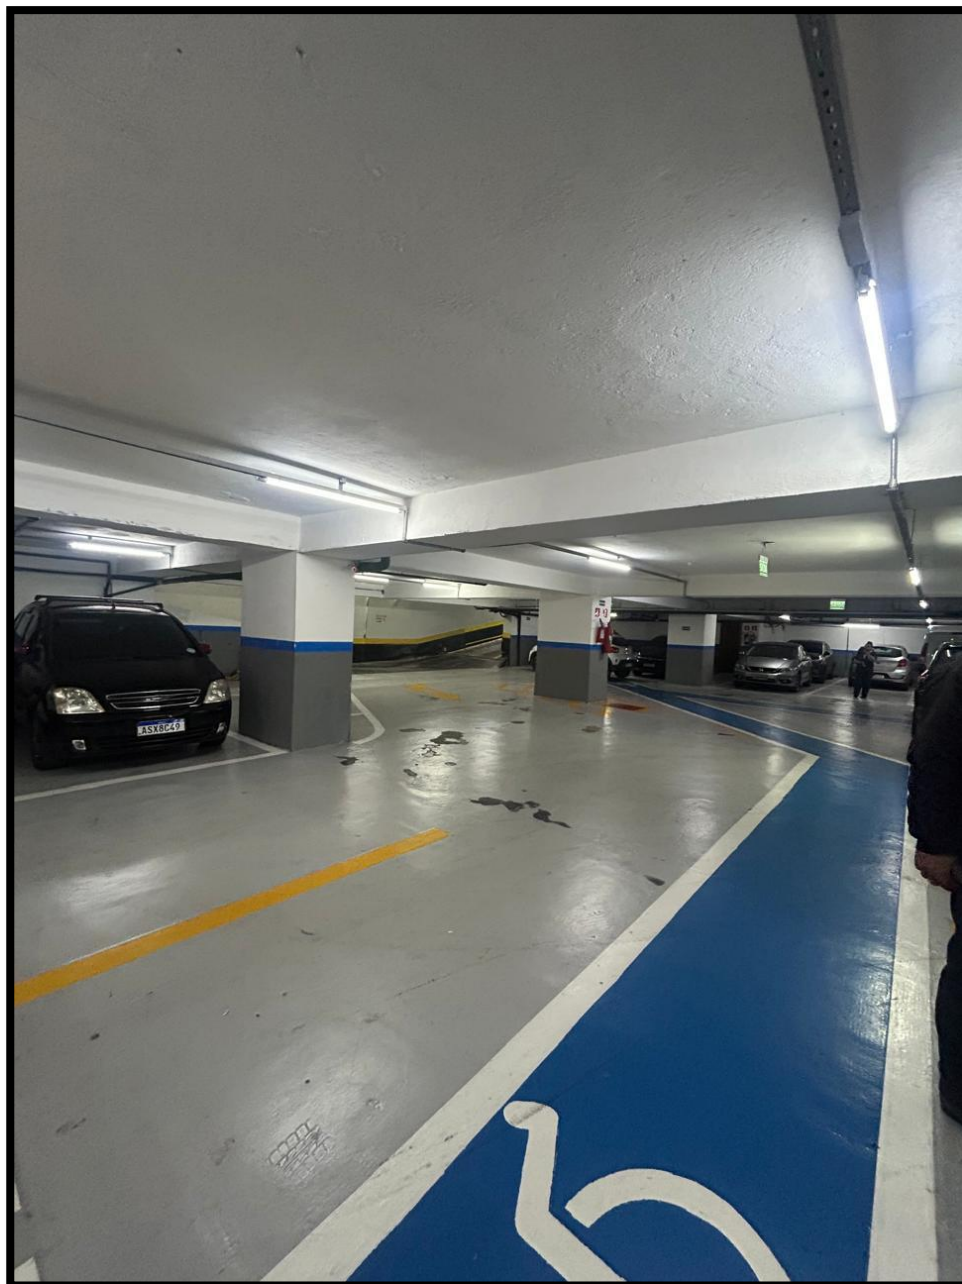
Ilustra o ambiente geral do pavimento subsolo.
